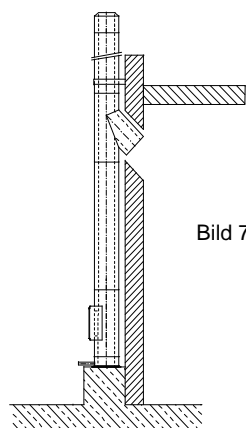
Aufbau mit Grundplatte für Sockelmontage
